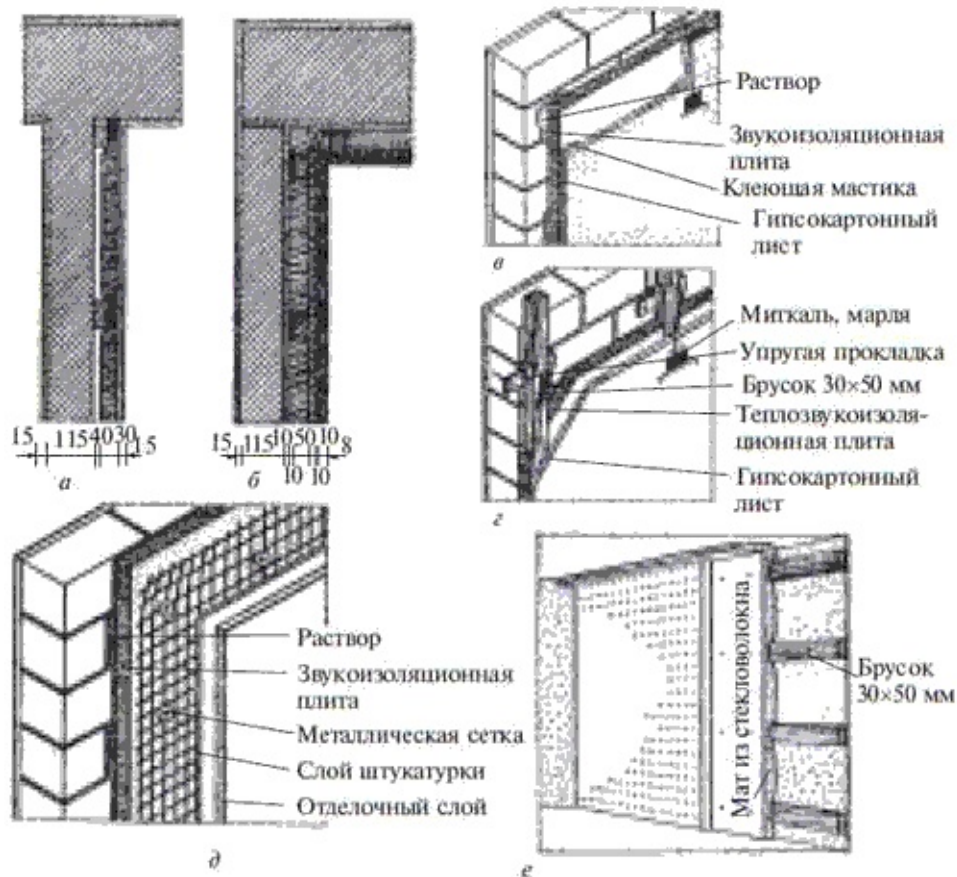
Усиление звукопроницаемости перегородок с помощью: *a* — звукоизоляционных плит и воздушного промежутка; *б* — звукоизоляционных плит на подкладке; *в* — звукоизоляционных плит и прикрепленных к ним гипсокартонных листов; *г* — звукоизоляционных плит и гипсокартонных листов, прикрепленных к брускам; *д* — звукоизоляционных листов и штукатурки по металлической сетке; *е* — матов из стекловолокна и перфорированных плит, прикрепленных к деревянному каркасу
